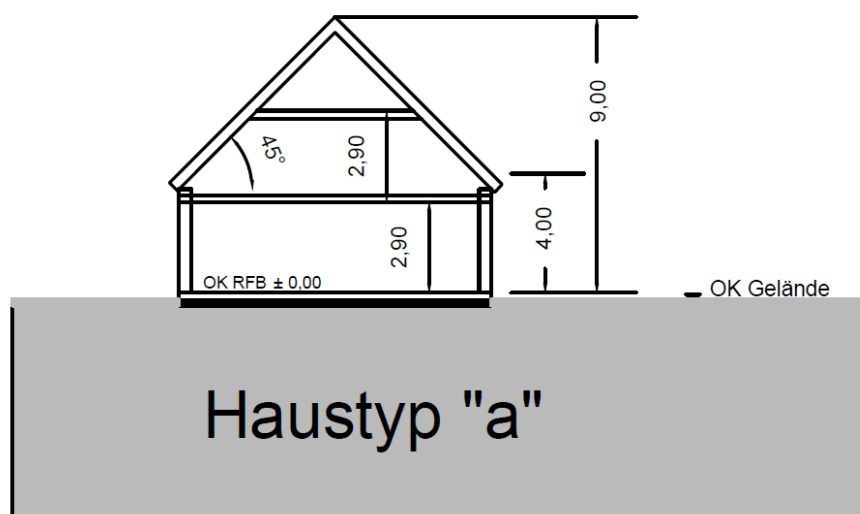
Systemschnitt Haustyp „a“ ein Vollgeschoss im EG und ein Vollgeschoss im DG
